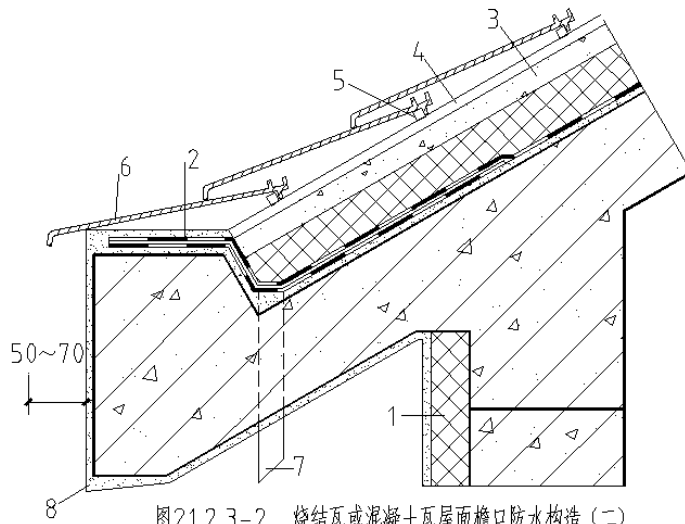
烧结瓦或混凝土瓦屋面檐口防水构造(二)
